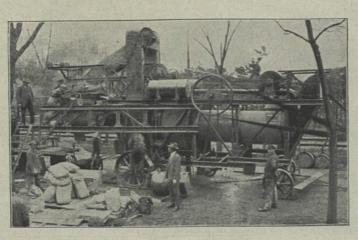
Straßenbaumaschine, die am Tag 200 m Walzasphalt= ftraße herstellt.
